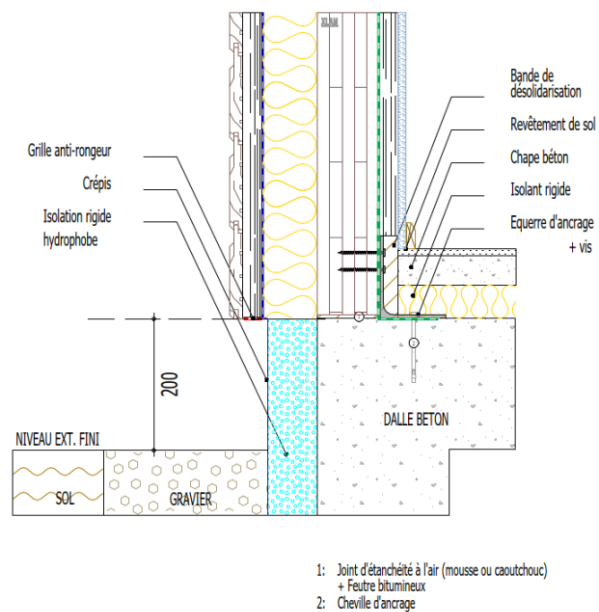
Détail d'un pied de mur XLAM sur Dalle béton
